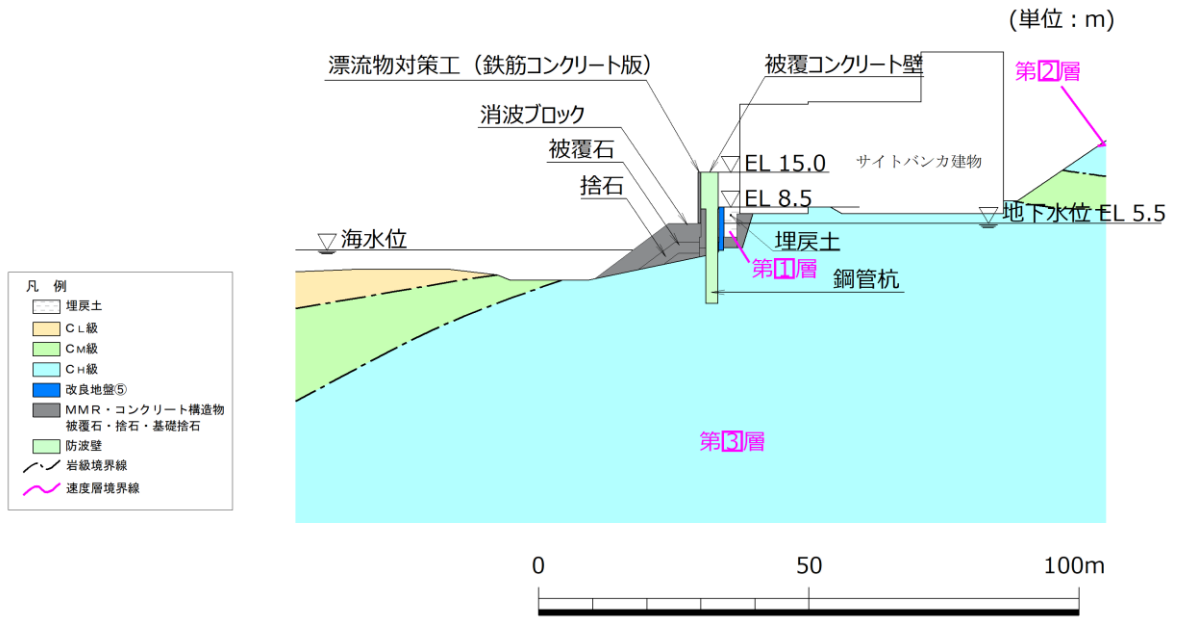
防波壁 (多重鋼管杭式擁壁) の横断面図 (⑤-⑤断面)
